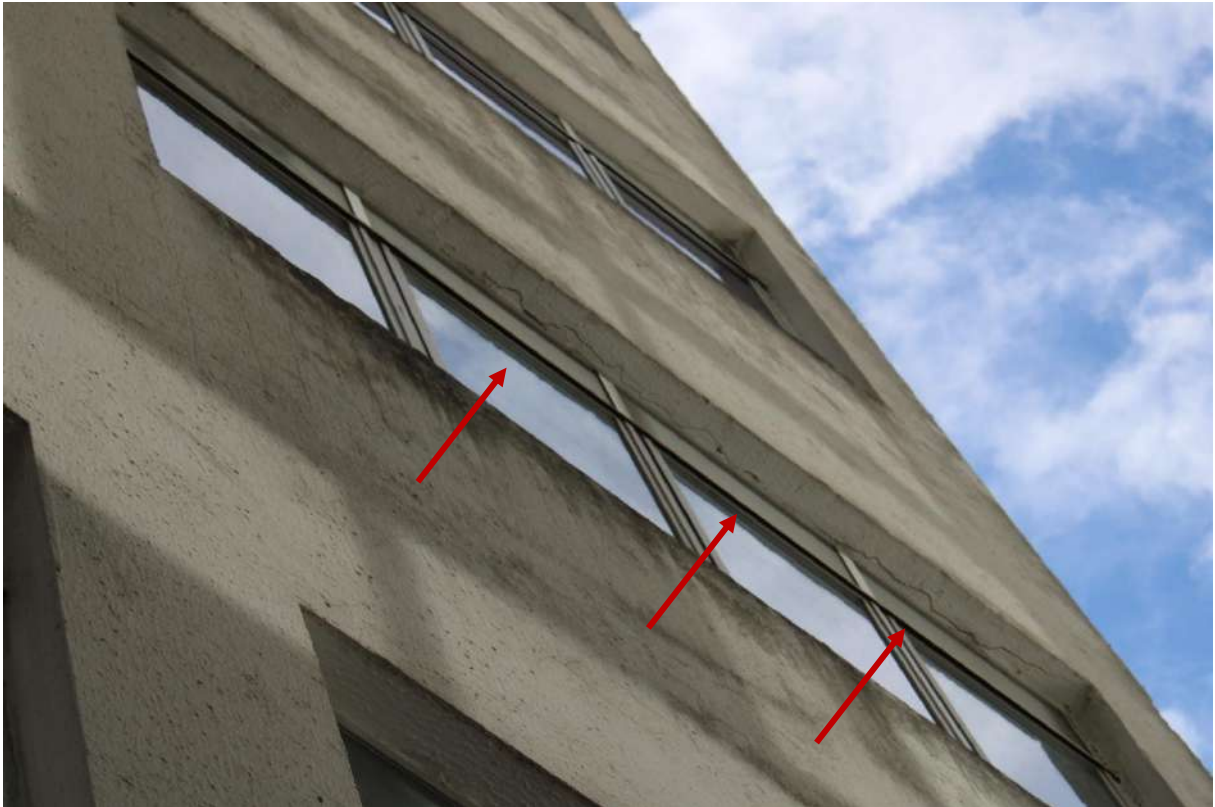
Fissura característica de processos de corrosão de armadura observada na fachada sul.
